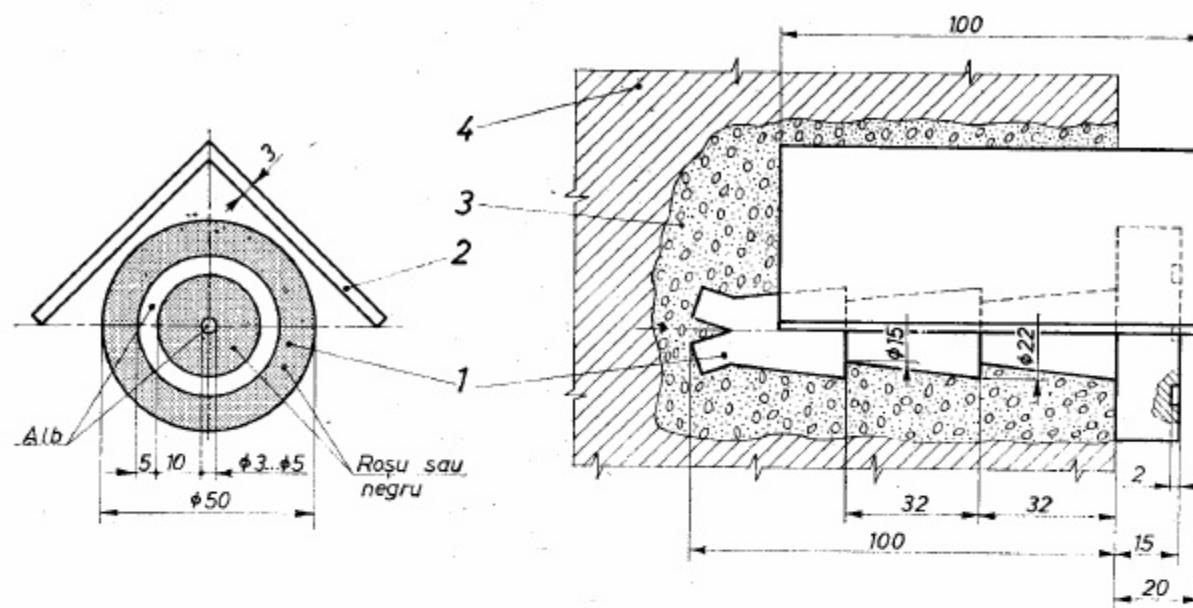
1 — marca de vizare; 2 — piesă metalică de protecție; 3 — beton simplu; 4 — elementul de construcție
